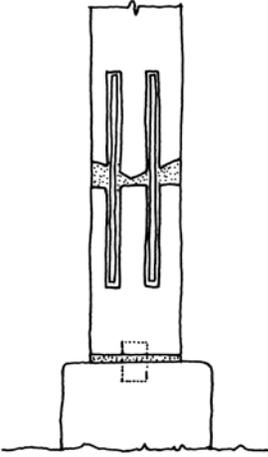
Consolidación del extremo dañado de un pie derecho con un tramo nuevo de madera conectado a la pieza original con barras encoladas.
